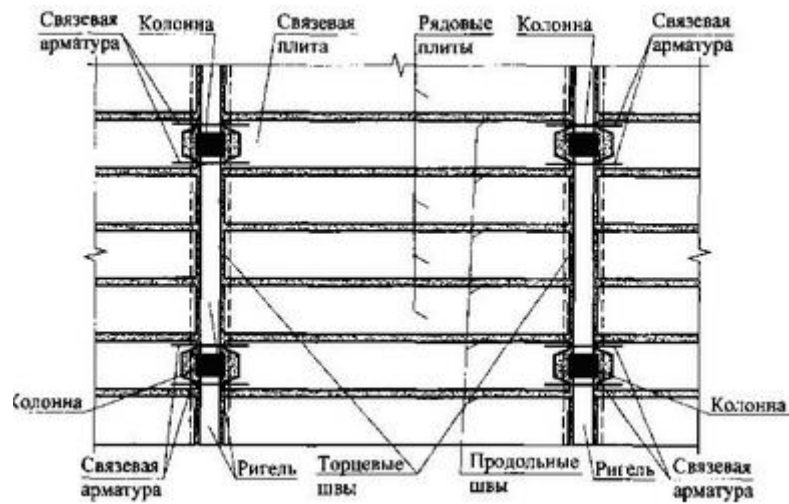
Фрагмент збірного перекриття з багатопорожнистих плит
